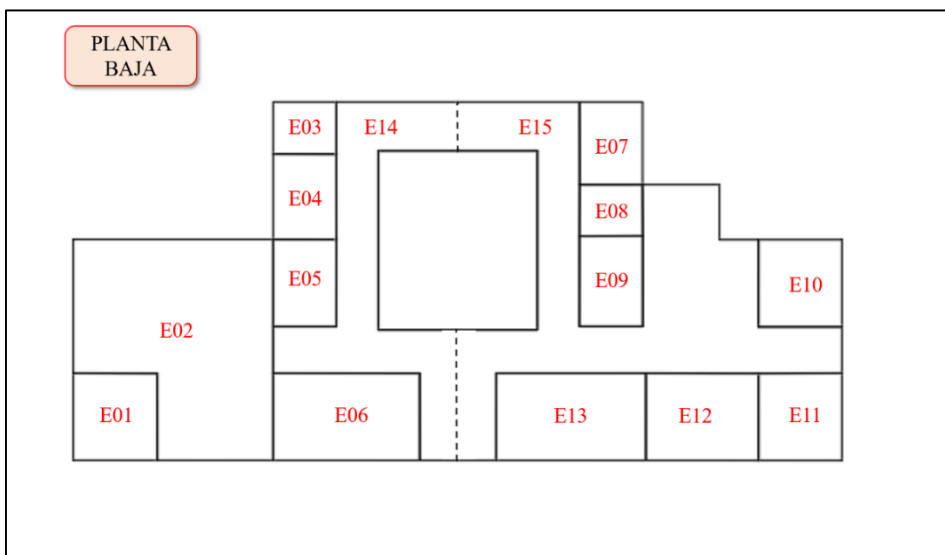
Zonificación de la planta baja. Fuente: Elaboración propia.
